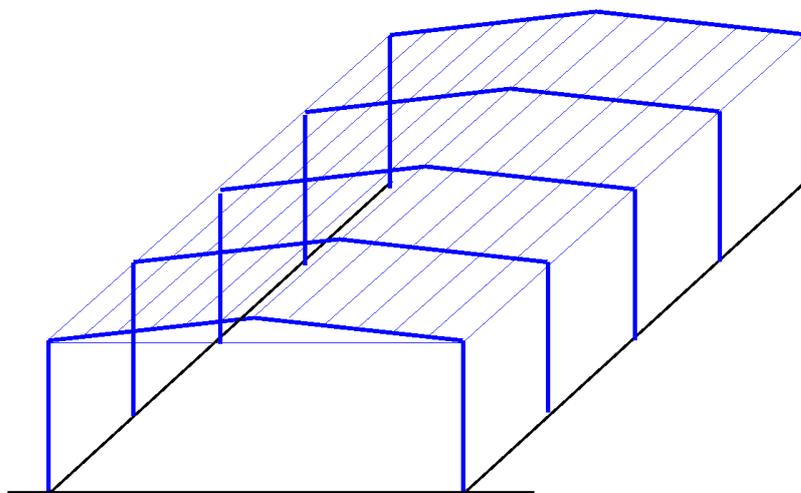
Esquema Galpón Tipo Pórtico. Fuente: Elaboración Propia.
